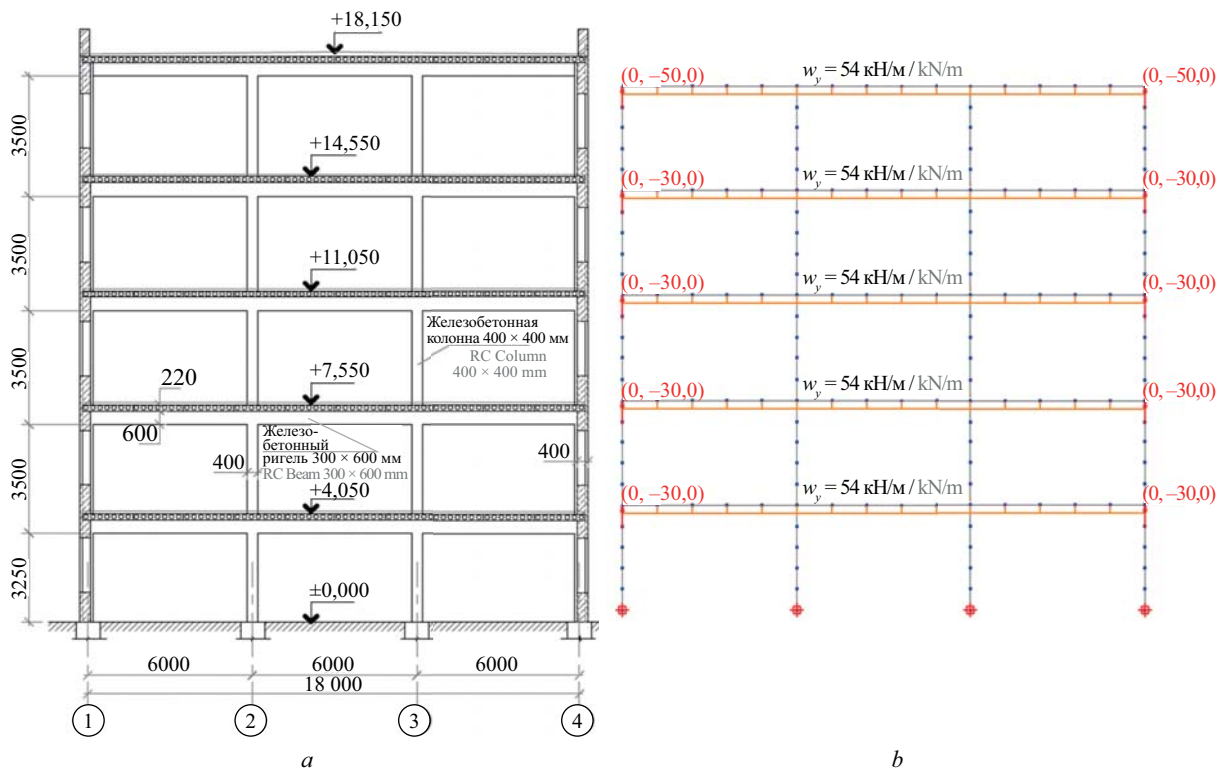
Конструктивная (а) и расчетная (б) схемы железобетонной рамы
